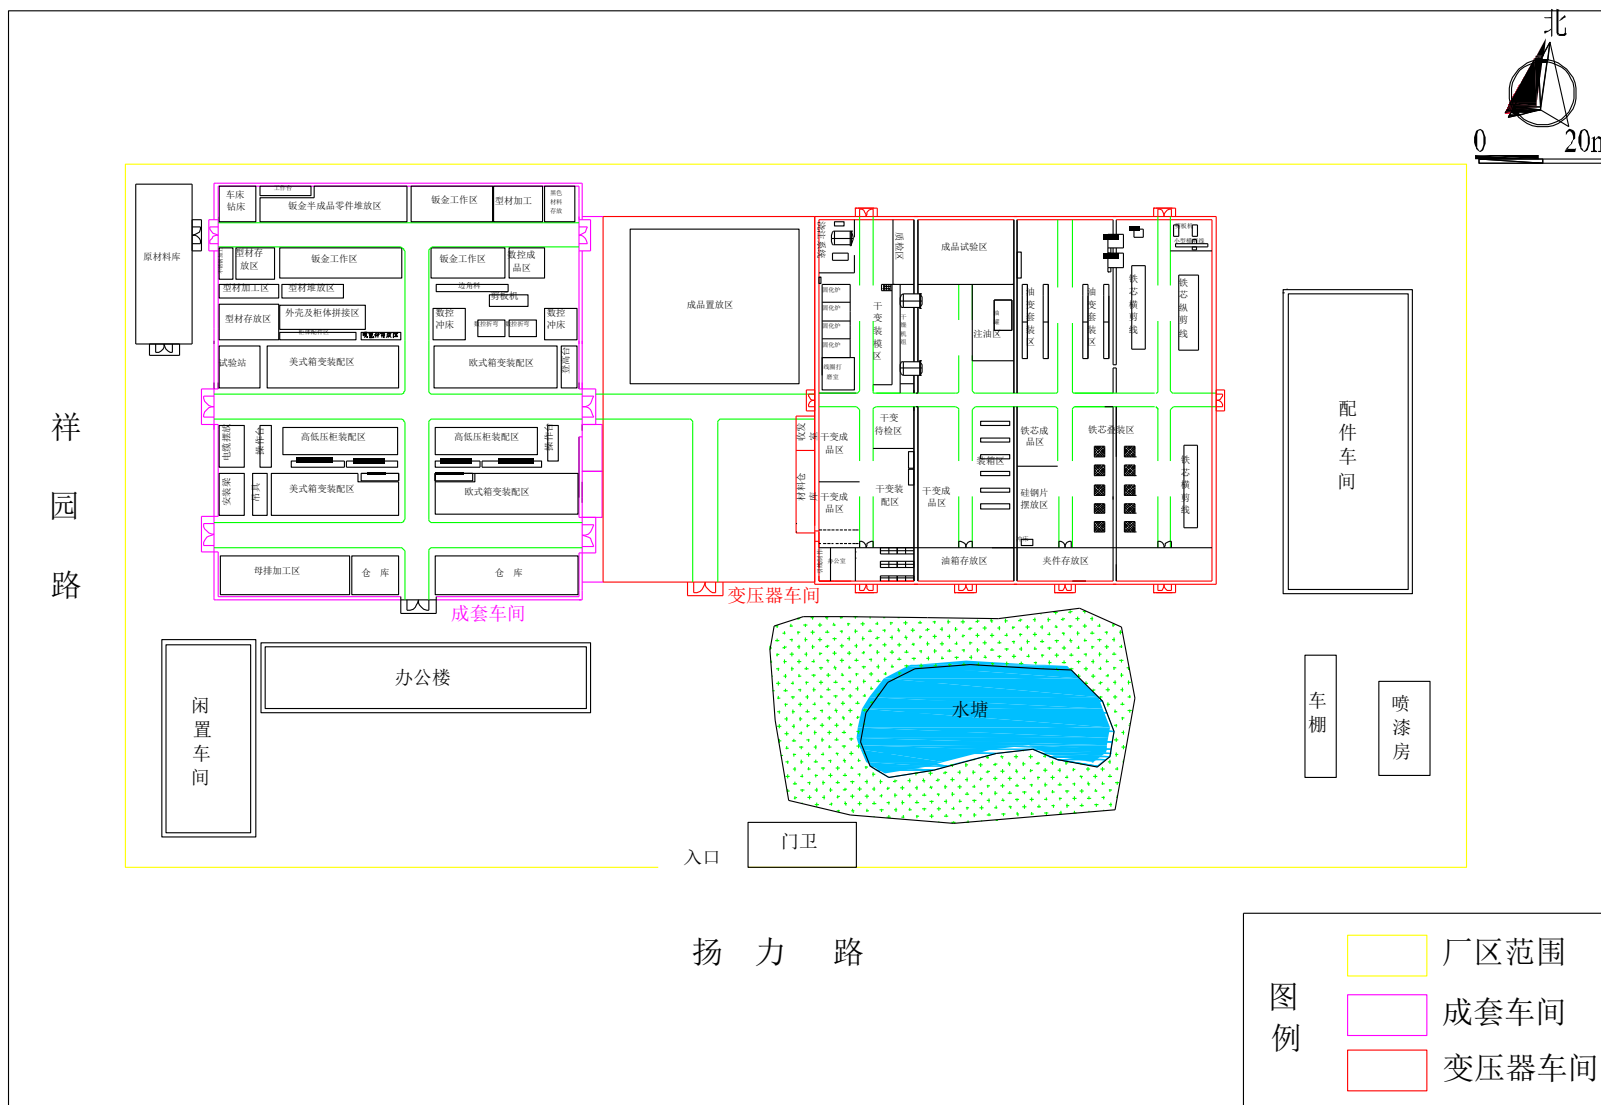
现有项目厂区及主要生产车间平面布置图
